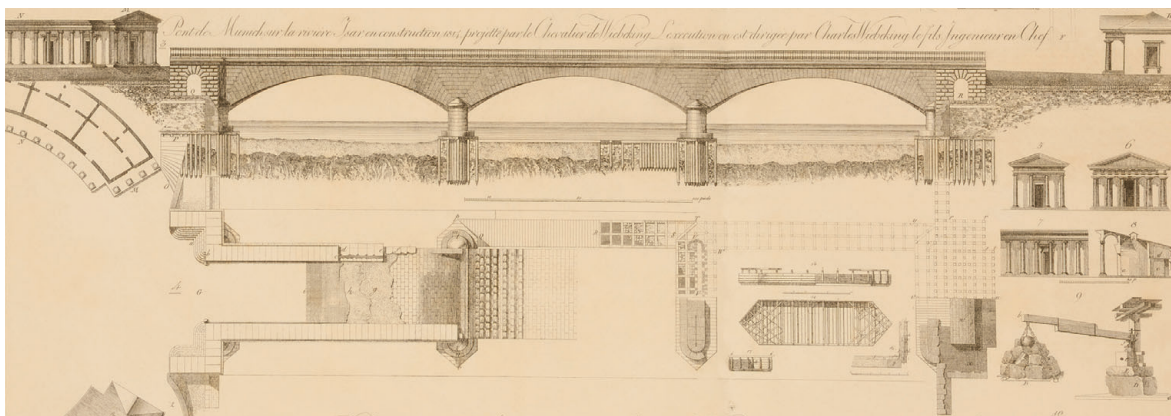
Lámina 133 de WIEBEKING, 1811-1814, que muestra el alzado y la planta del puente de Múnich, sobre el Isar, proyectado por Wiebeking en 1814, con una relación  $c/L = 1/24$ , igual que la utilizada por Perronet en Neuilly (no tengo constancia de que exista este puente en el momento presente).
